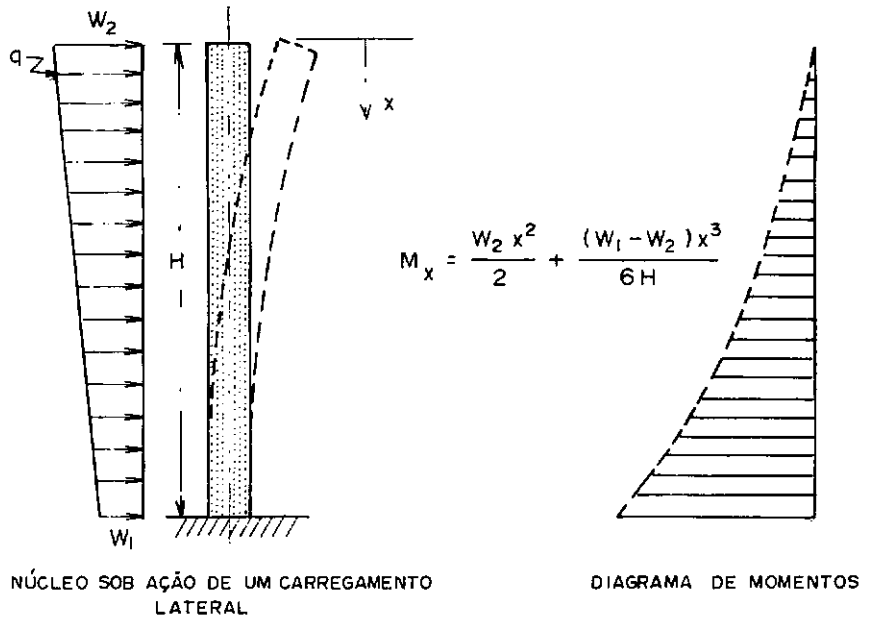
Comportamento de uma viga em balanço sob carregamento lateral
